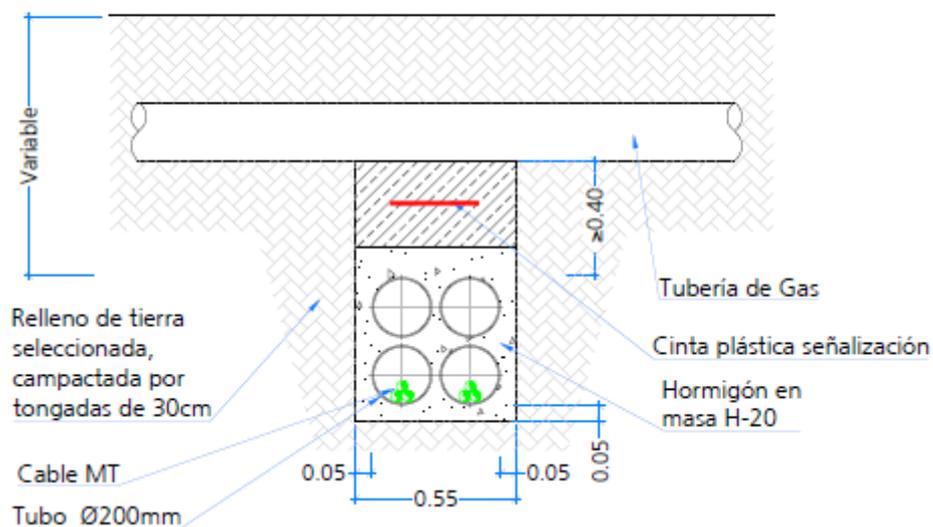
Características constructivas de la zanja en cruce con canalizaciones de gasoducto.
